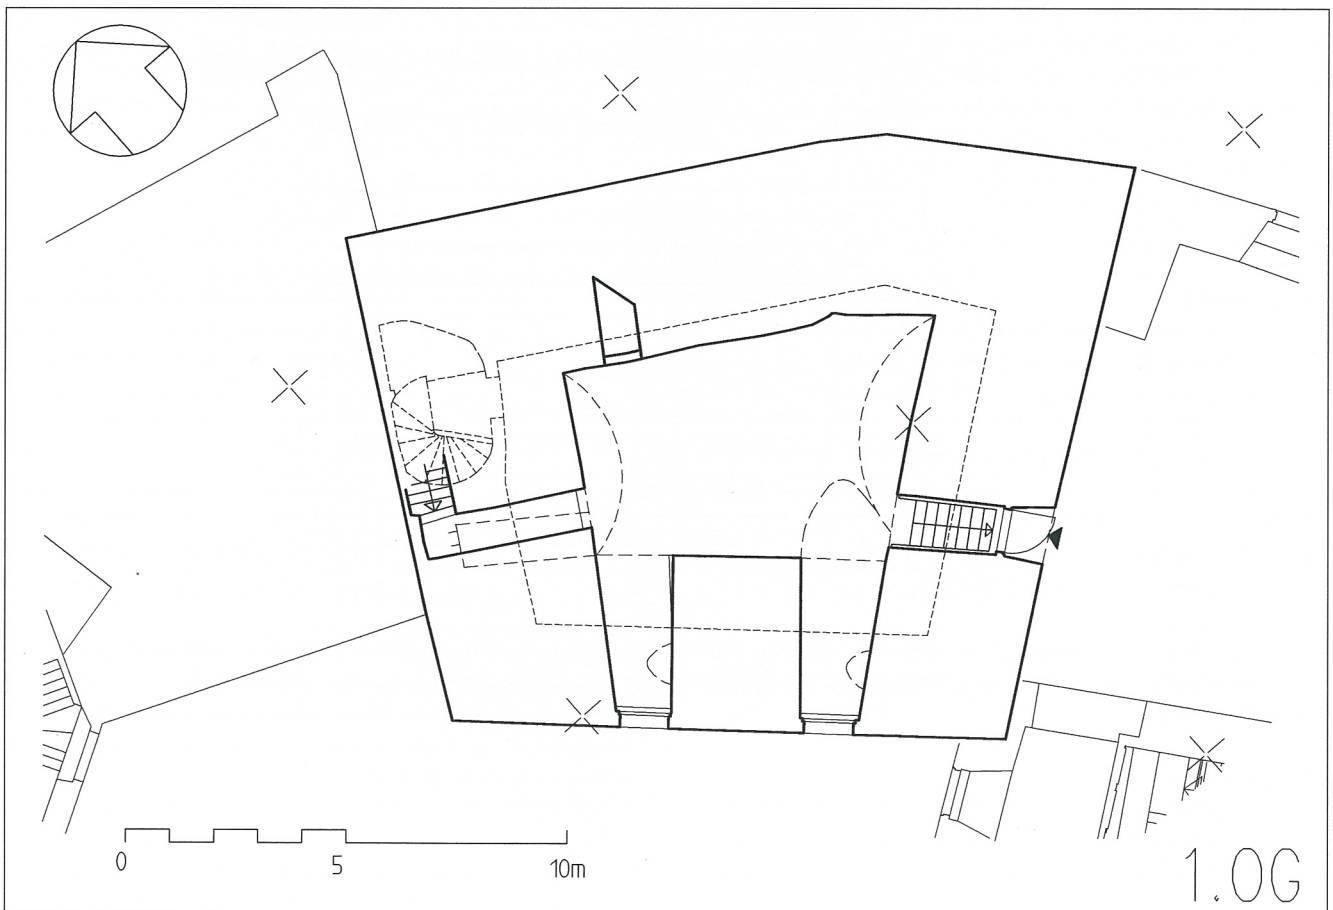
Grundriss 1. Obergeschoss „Silberkammer“, dünn darübergezeichnet das 2. Obergeschoss mit der blind nach unten führenden Treppe.
